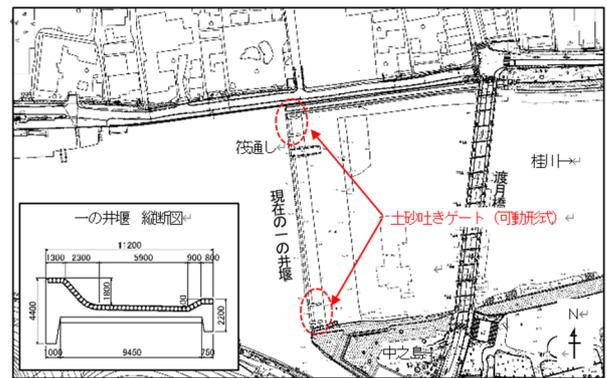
現在(2013年)の平面図と一の井堰の縦断面図^{加筆}
